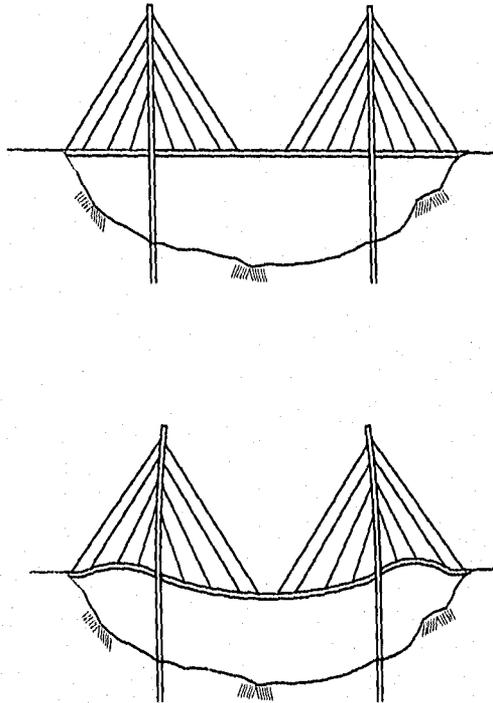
Si el puente se supone construido sin carga en su geometría final (dibujo superior) al introducirle las cargas permanentes en toda la estructura, se producirán deflexiones; Por lo tanto las pre-deformaciones son las deformaciones correspondientes a los acortamientos de los tirantes para restaurar la geometría deseada.
